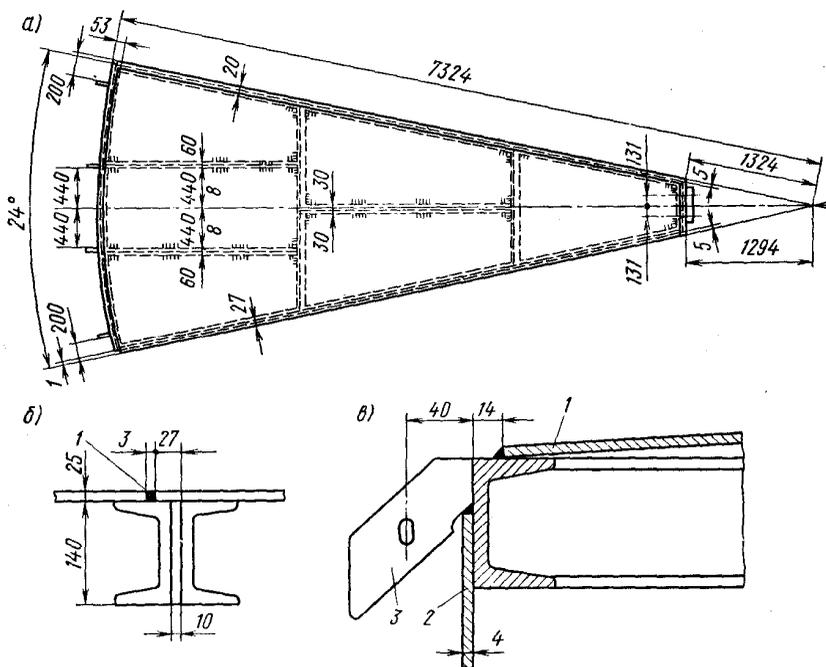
Типовой щит кровли (а) и монтажные соединения щитов (б, в)
